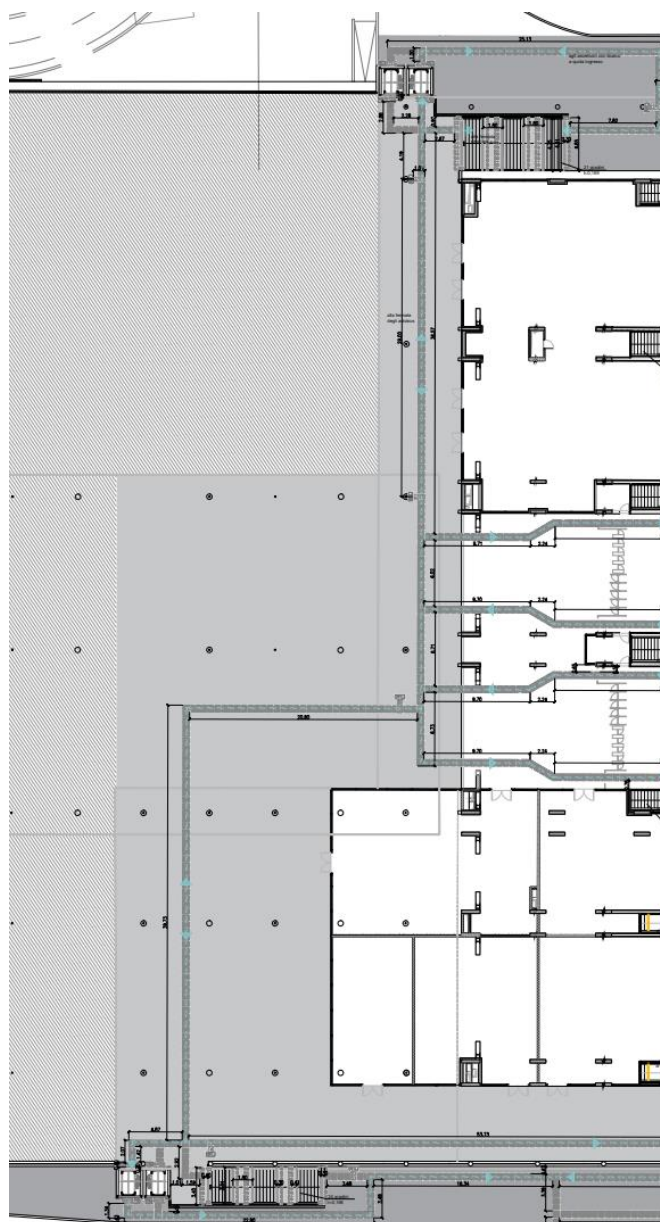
Stralcio Planimetria percorsi tattili Piazzale lato Milano.
